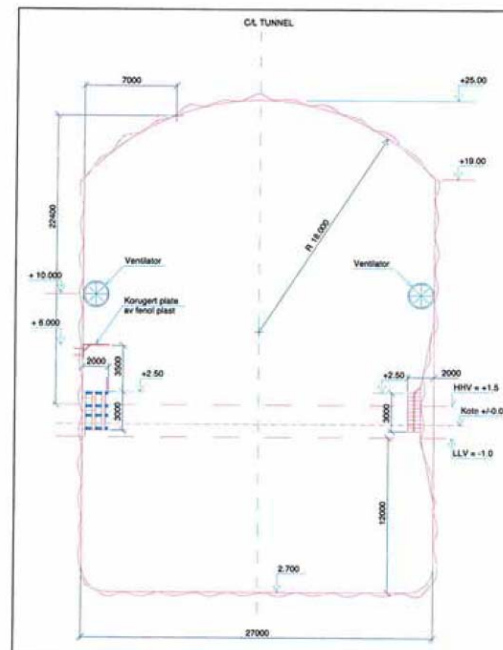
Tunnelverrsnitt Stor Tunnel
